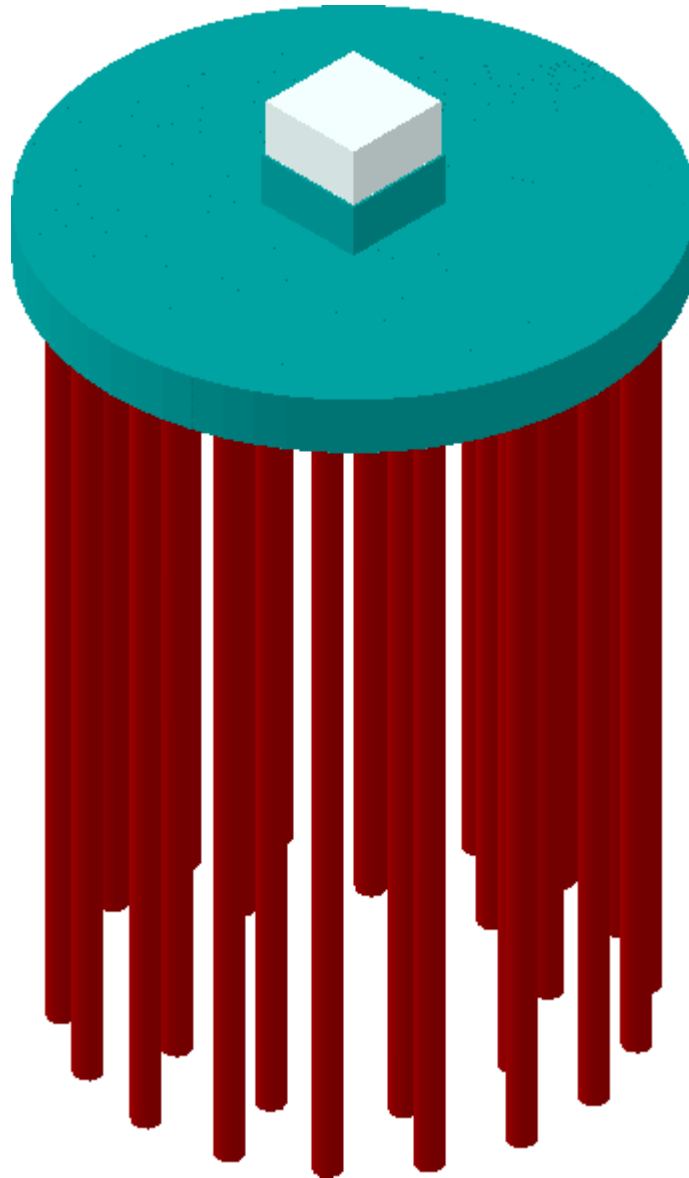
Modello strutturale 3D per le verifiche delle strutture di fondazione
